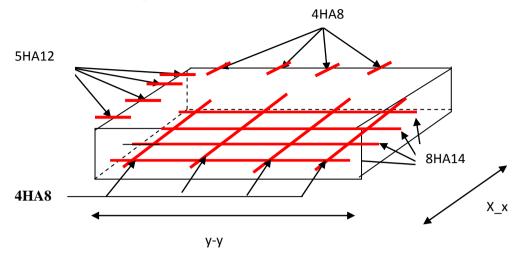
Schéma de ferraillage de la dalle pleine.
